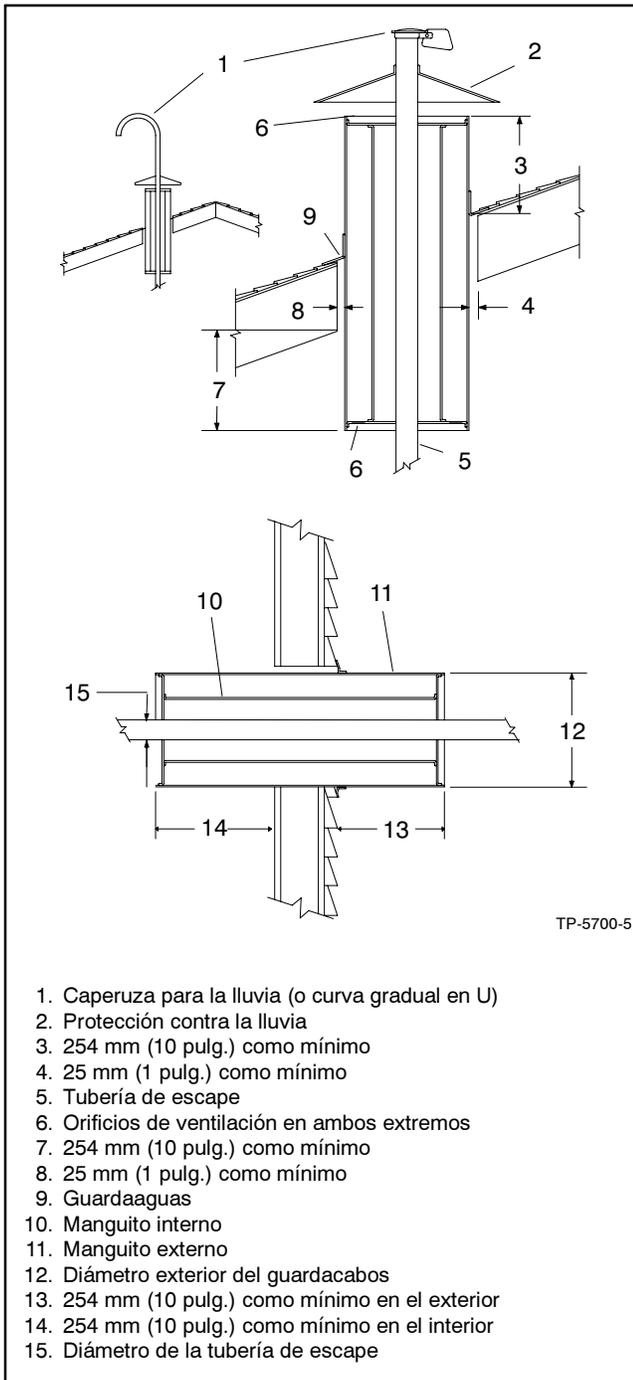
Guardacabos de manguitos doble y caperuza para la lluvia
